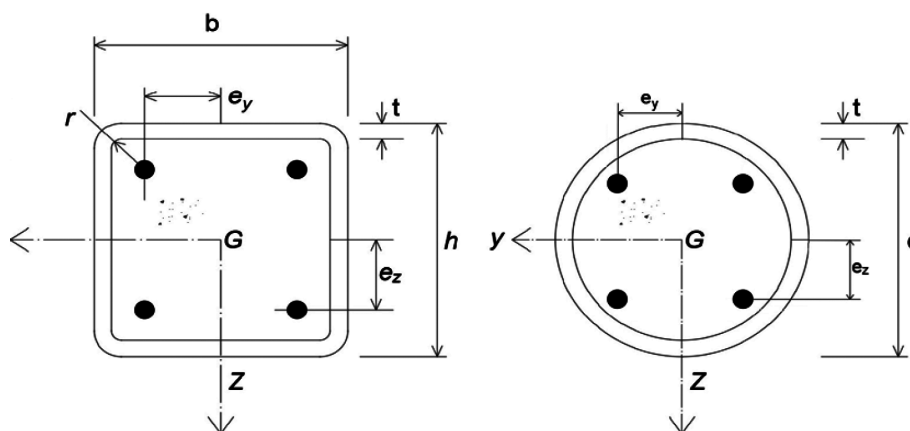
Заполненные железобетоном прямоугольные (а) и круглые (б) полые сечения, заполненные бетоном
